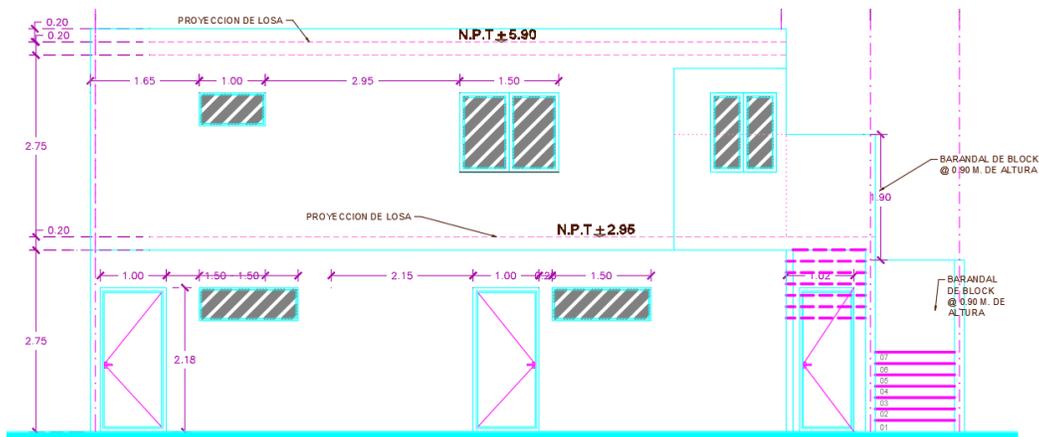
Vista frontal de baños públicos (planta baja) y oficinas (planta alta).
